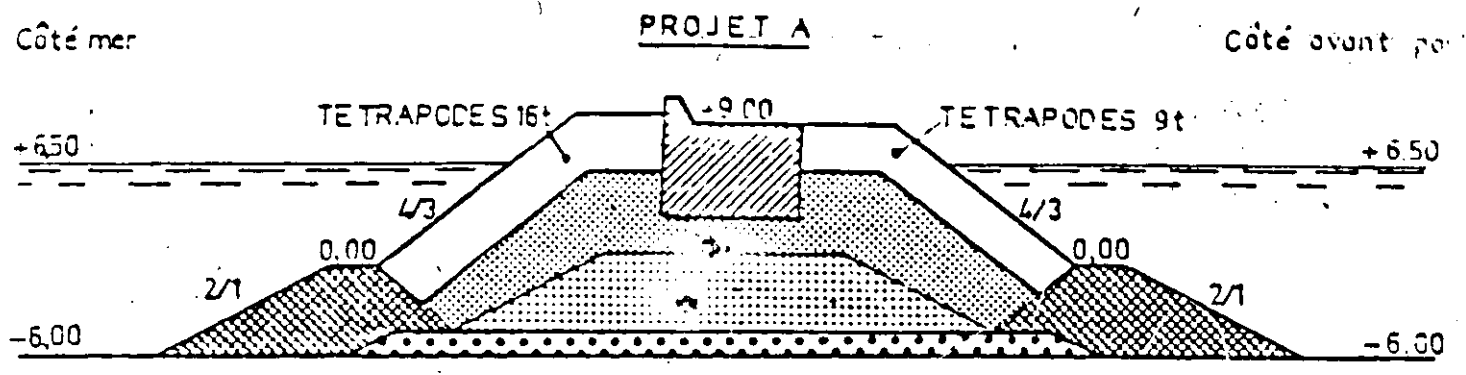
COUPE-TYPE DE LA JETÉE OUEST
